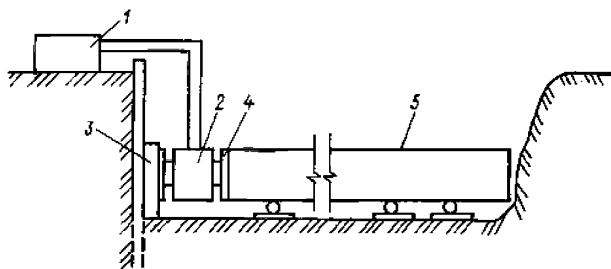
Схема прокладки трубопроводов способом продавливания:
